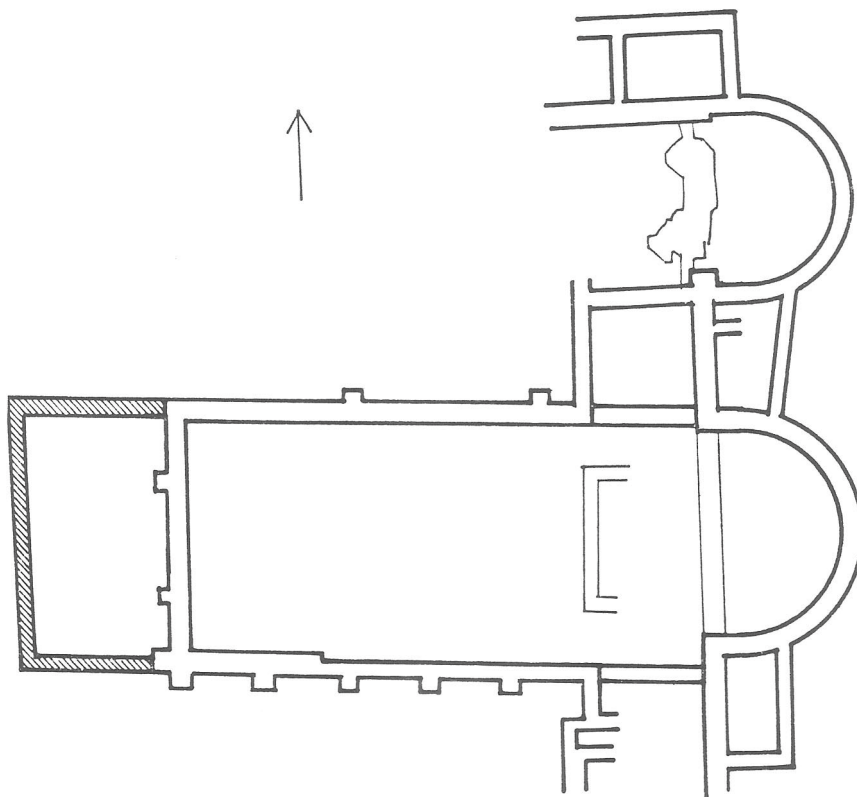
Chiesa sul Doss Trento, planimetria.
